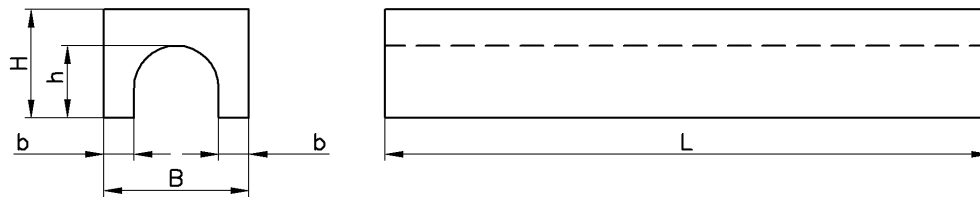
Voorbeeld van een betonnen kabelbeschermer
